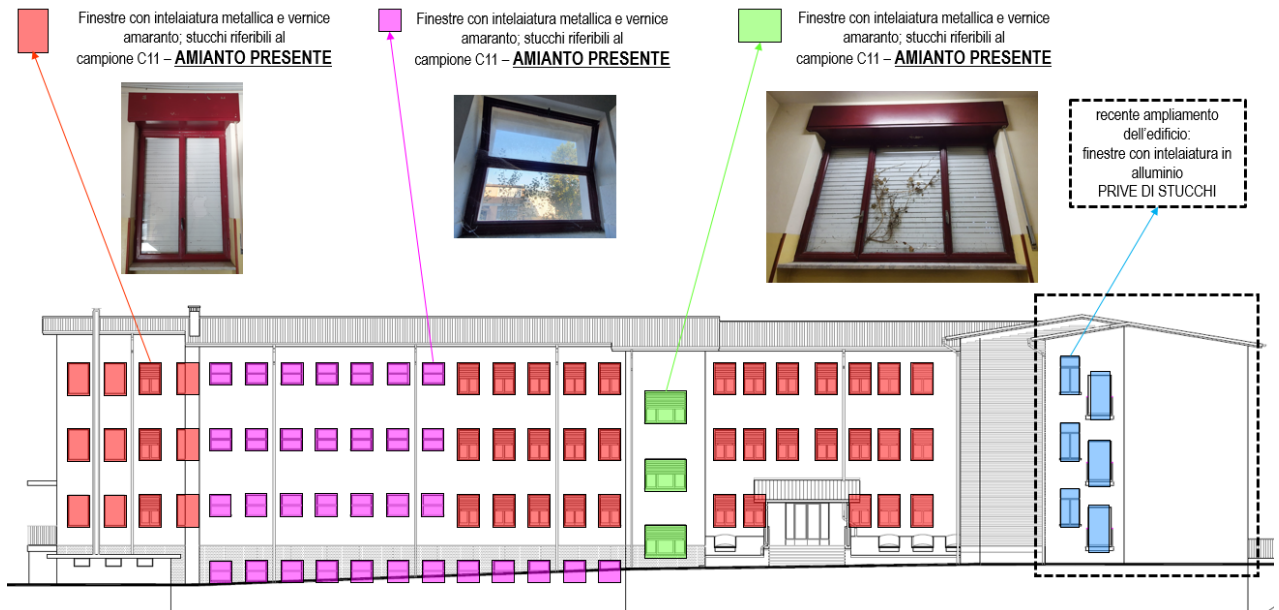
Finestre e stucchi – Ed. B Prospetto verso sud
